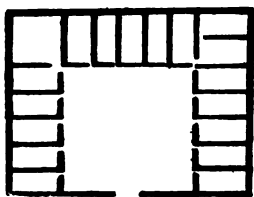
PLAN D'UNE MAISON A COUR CENTRALE
